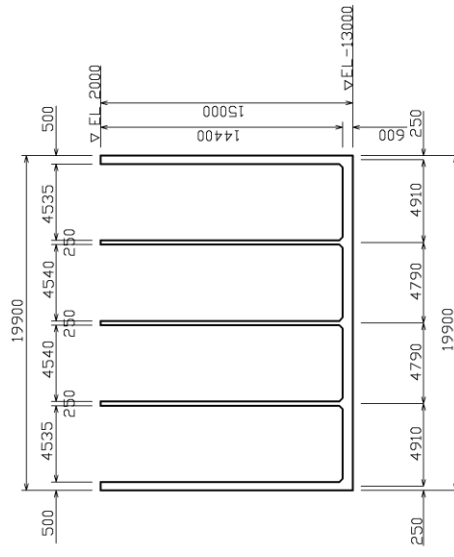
防波壁 (波返重力擁壁) のケーソン構造図 (②-②断面) (断面図)
